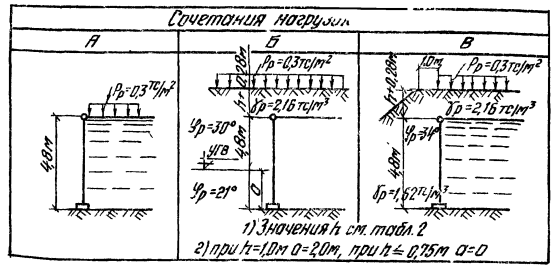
Схемы расчетных нагрузок на покрытие резервуара.
